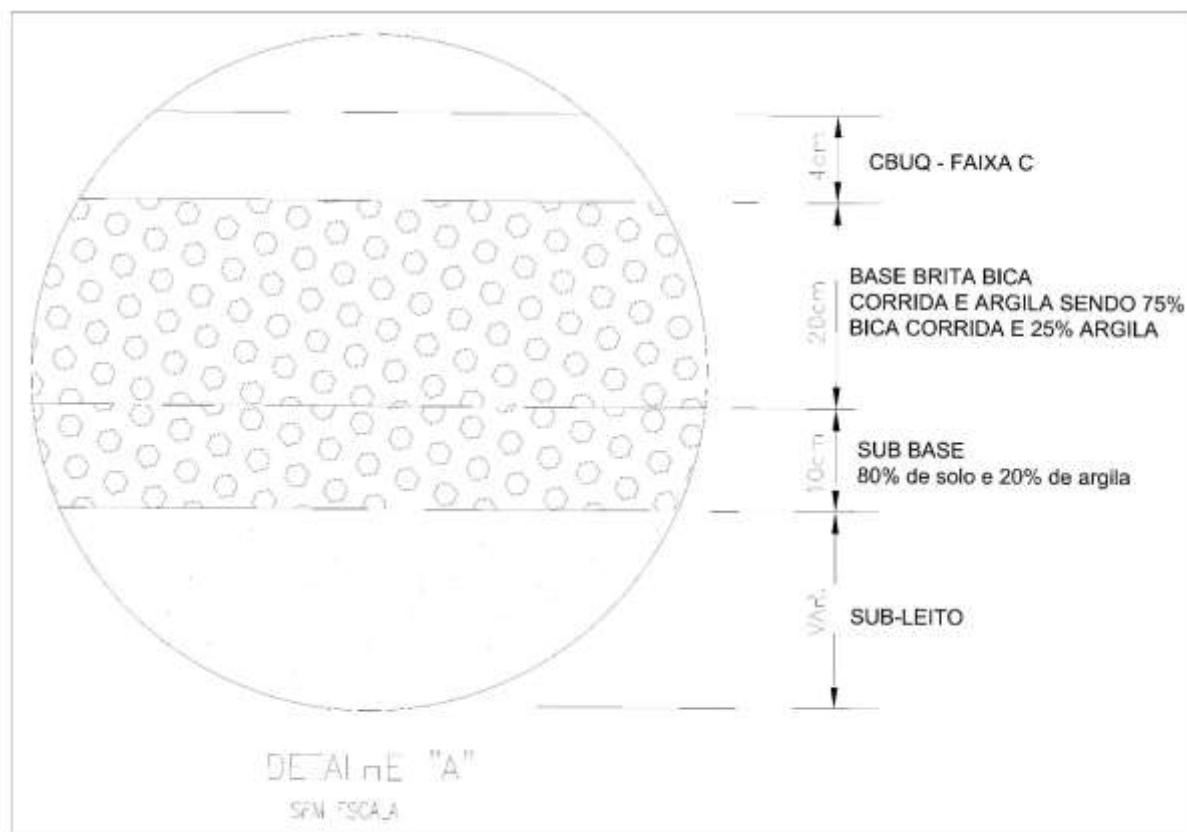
Detalhamento da Seção Tipo Pavimentação
